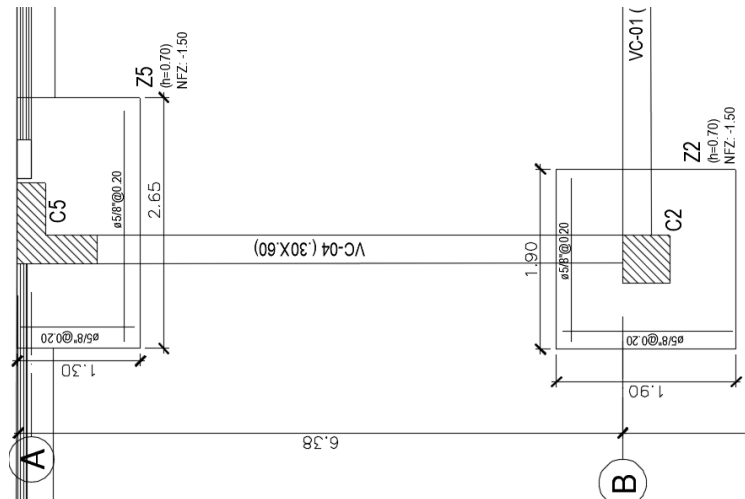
Modelo de zapatas conectadas mediante viga de cimentación VC-04
